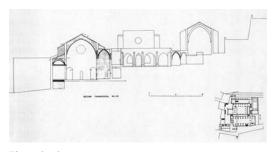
y 3 Planta y sección del conjunto conventual con indicación de las dependencias
